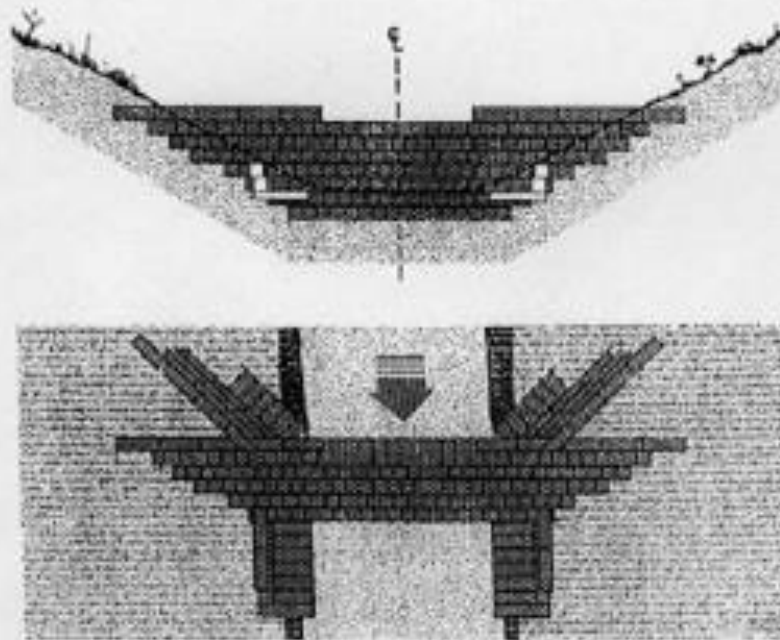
Presa filtrante de gaviones con muros de encauzamiento [6]
